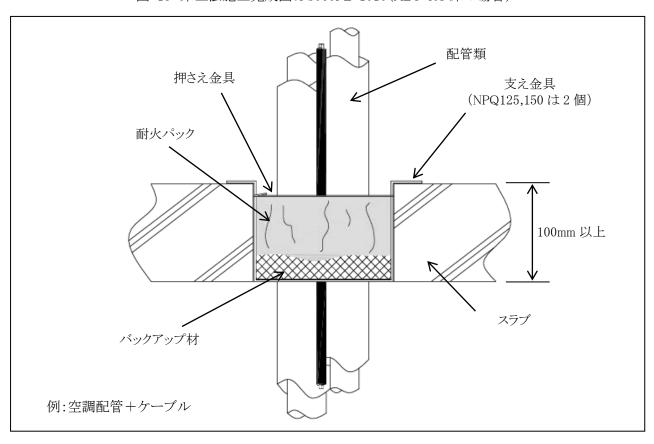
床工法施工断面図:PS060FL-1010(ALC·RC 床の場合)
